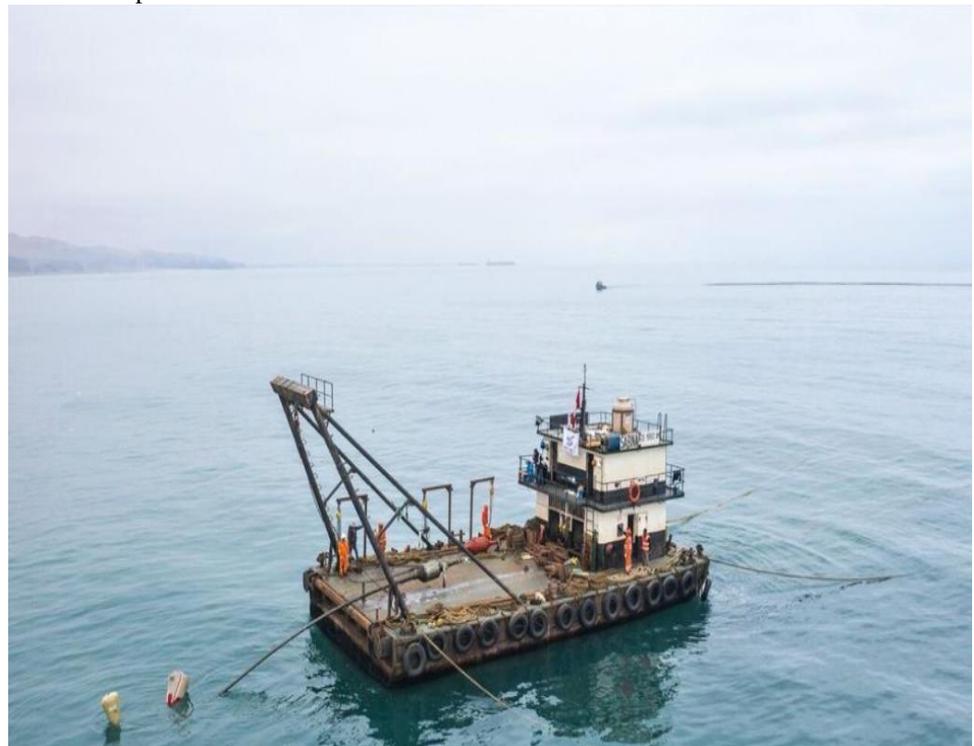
Perforación horizontal dirigida – Proyecto PTAR Pachacútec – Pipe Side.
